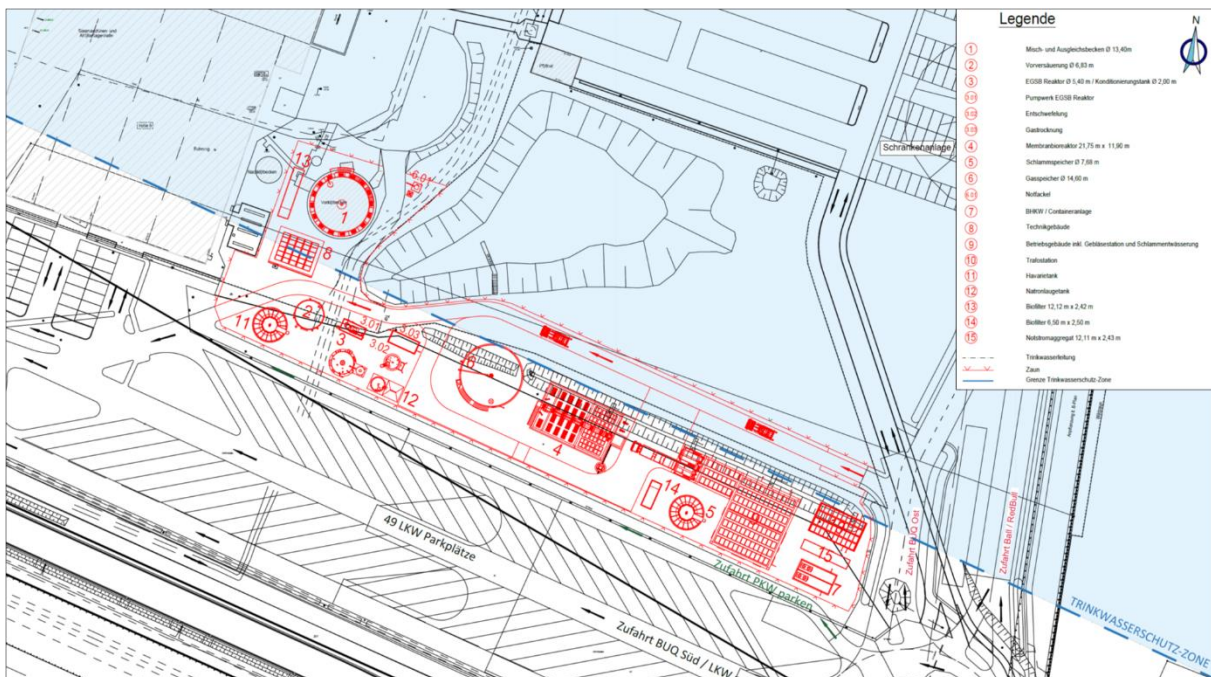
Lageplan mit Kennzeichnung der jeweiligen Komponenten der Kläranlage
